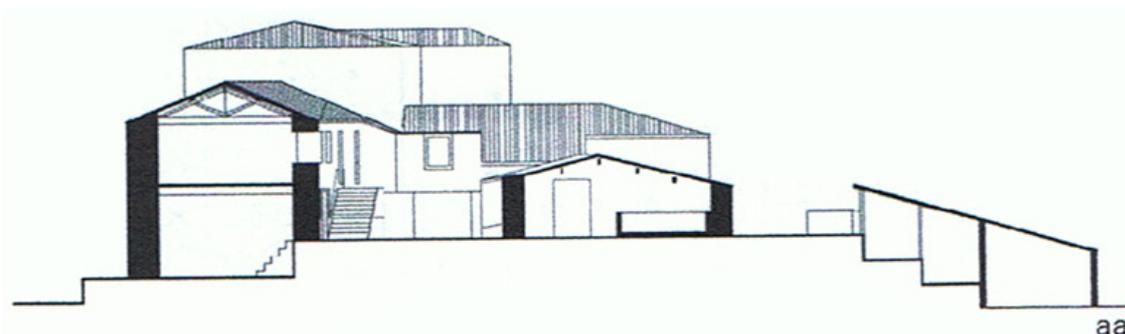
Corte aa' da planta da Quinta do Paço de Monsul (retirado de [4])
